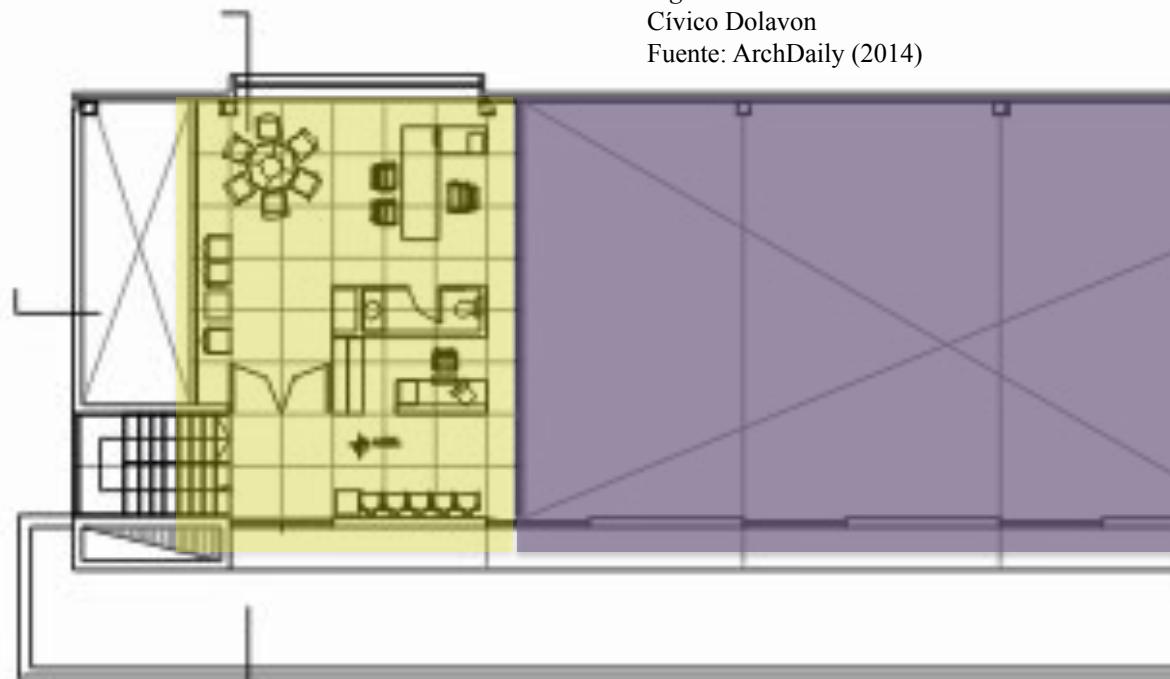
Planta Arquitectónica del Edificio Municipal y Centro Cívico Dolavon
